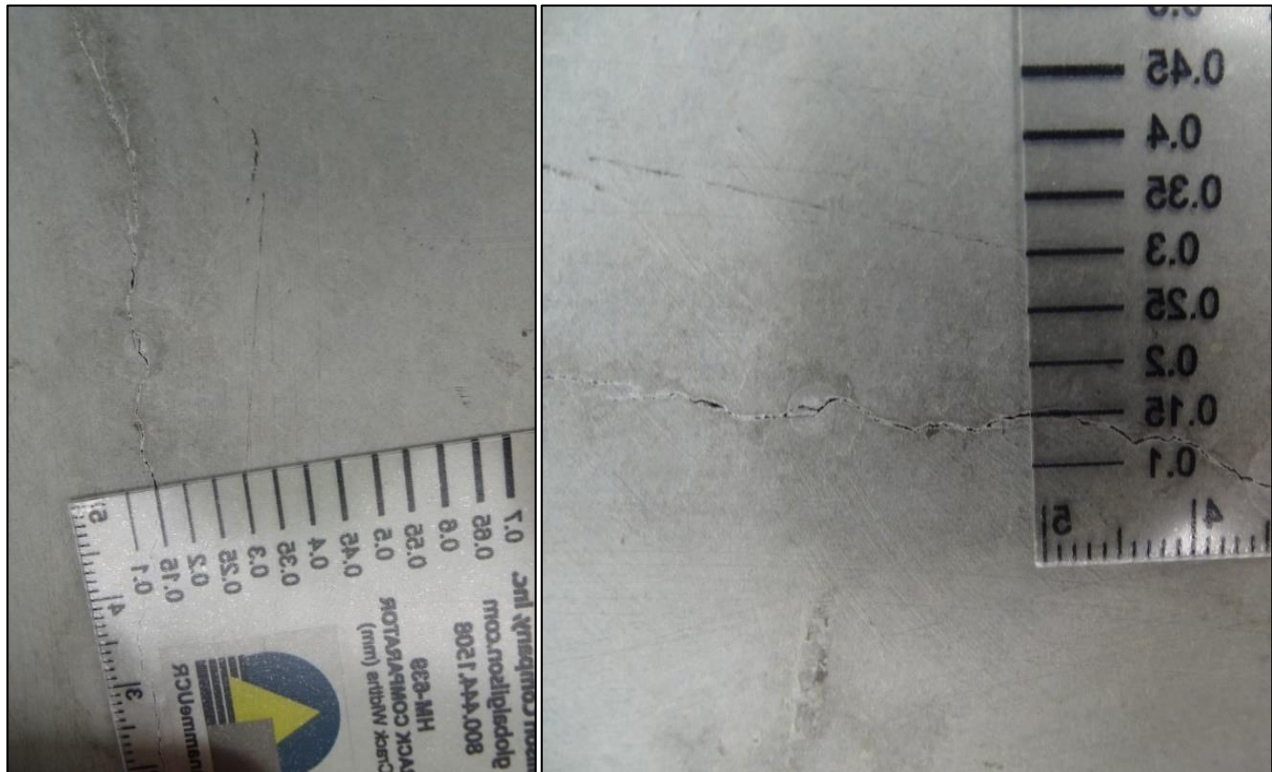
Anchos de grieta medidos en sitio menores a 0,2 mm en la condición inicial de las 2 vigas prefabricadas inspeccionadas.
